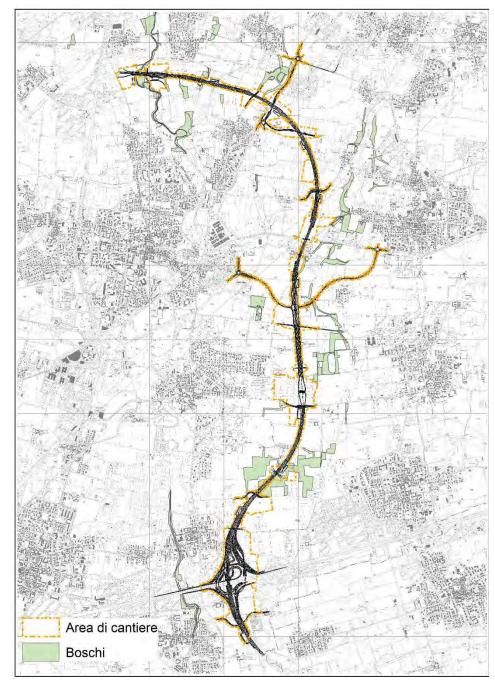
Localizzazione delle superfici forestali rispetto alle aree di cantiere
